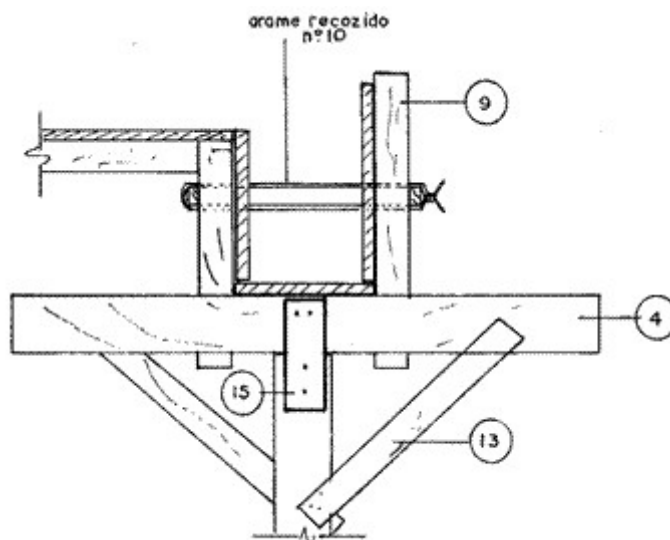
Sistema de montagem de fôrmas para vigas [Fonte: Blog Construção Civil Tips 2012]
